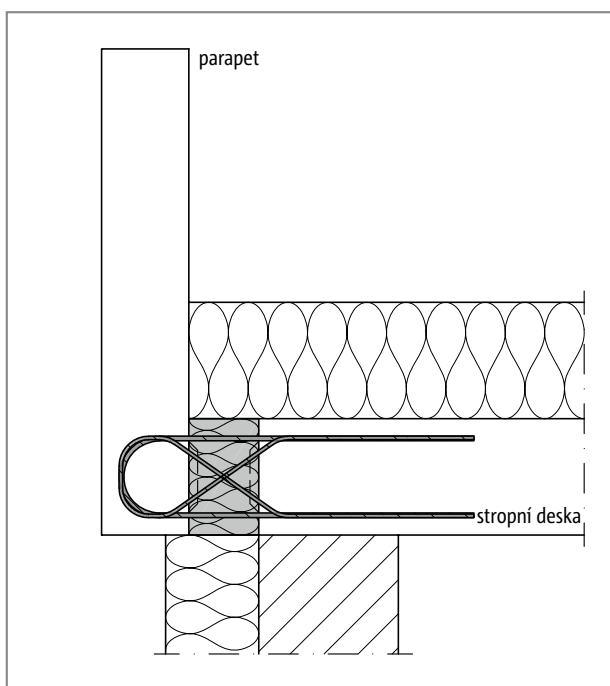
Schöck Isokorb® XT typ AP - svislé zabudování: Pohled, uložení parapetu resp. atiky na stropní desce
